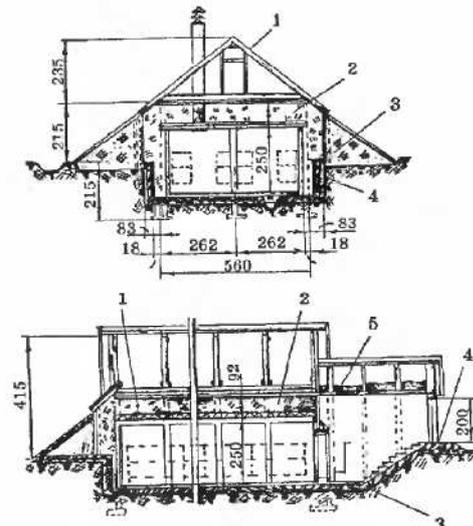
Поперечный и продольный разрезы полуподземного зимовника (размеры в см): 1 — шифер; 2 — солома о хвоей; 3 — грунт; 4 — глина; 5 — земля с соломенной резкой
